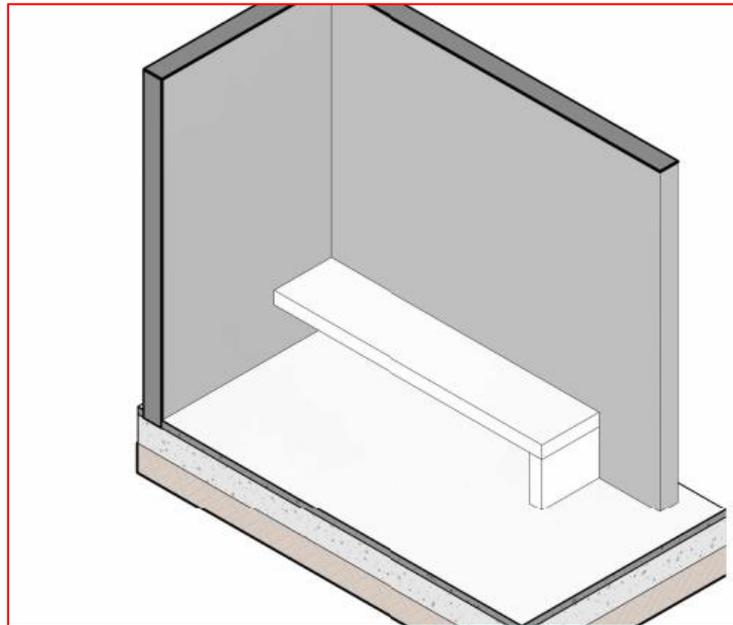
Banco de Concreto moldado in-loco - Fonte: CEASA/PR e AUEN
